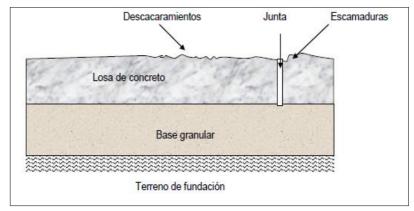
Fenómeno de Descascaramiento y Escamaduras en Losas de Concreto, de Cemento Portland.
